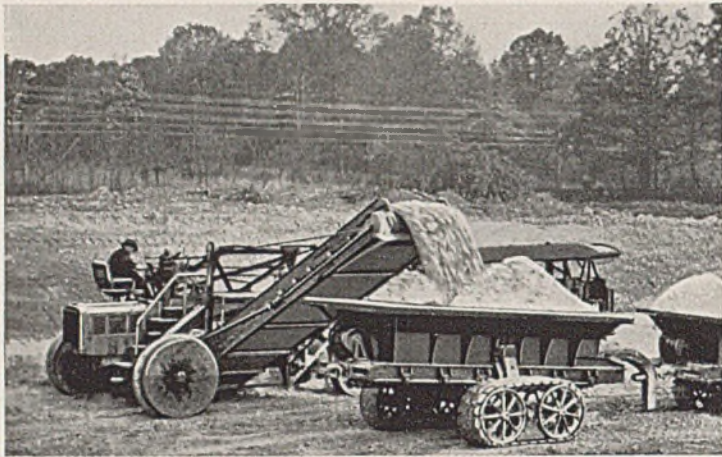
Planierbagger (elevating grader) beim Beladen eines Anhängewagens auf Raupen.
